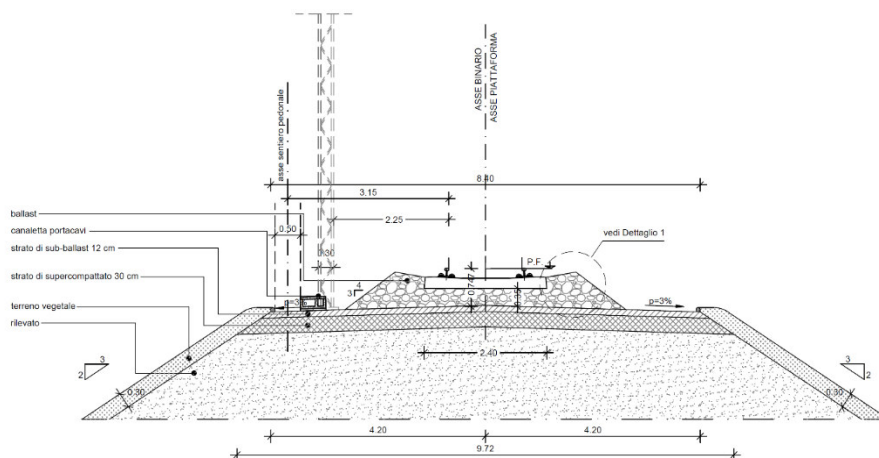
Sezione tipo ferroviaria in rilevato a singolo binario in rettilifo
